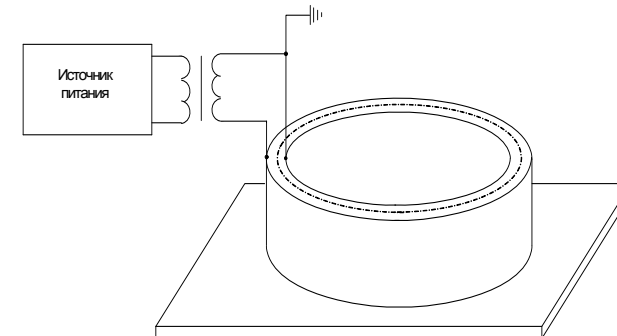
Схема электротепловой обработки железобетонного кольца электродным методом.
